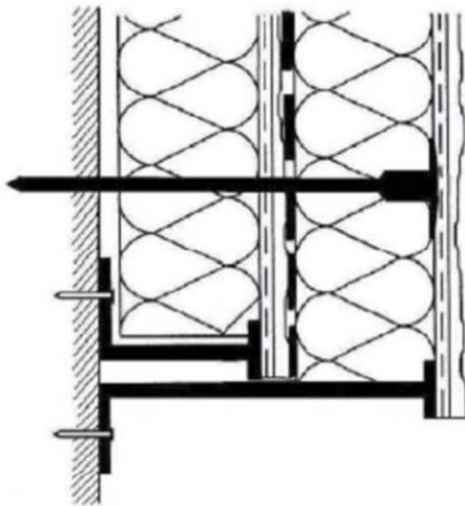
Exemples de traitement des points singuliers en surisolation
